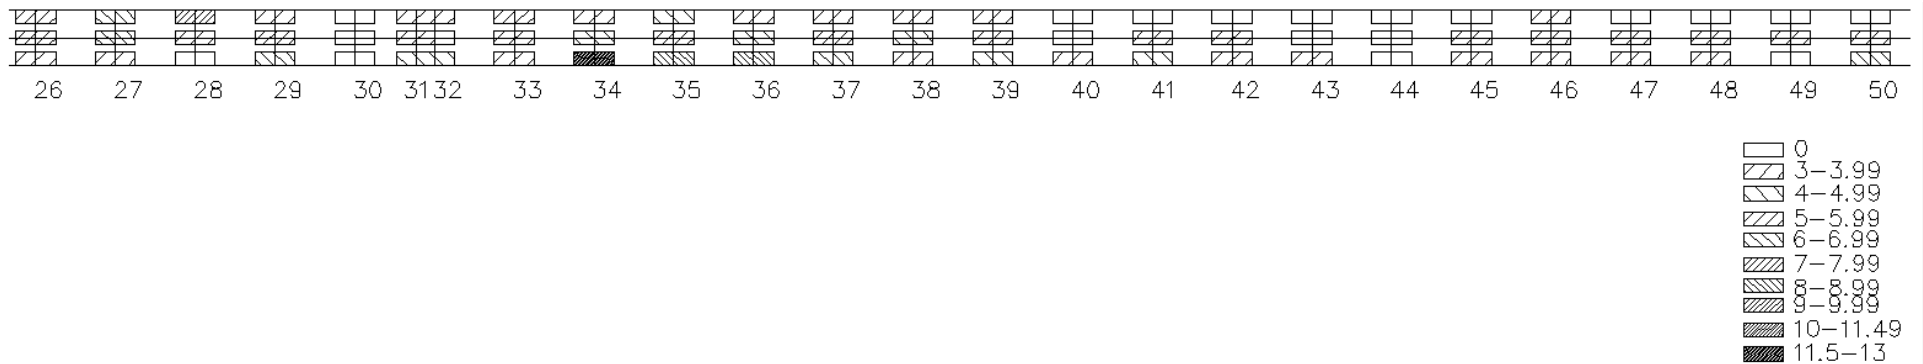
Ausgleichsdicken bei Tangenten und quadratischen Parabeln und Verfahrensplan Typ V, Grundriss, Stationen 26-50
